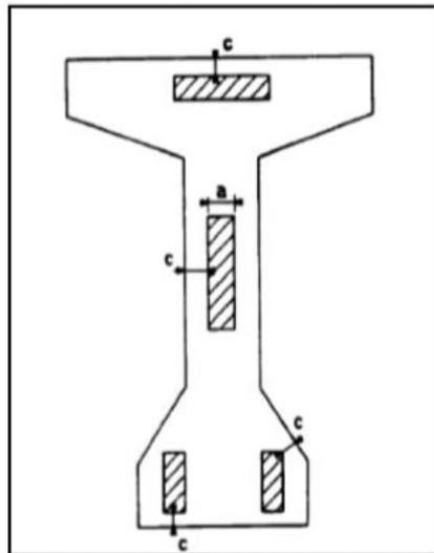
L'enrobage minimale c d'une conduite (gaine)
